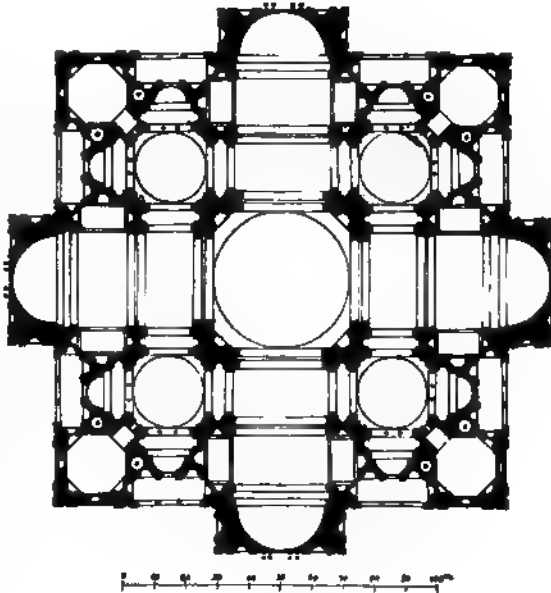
Grundriss von St. Peter (Bramante)
